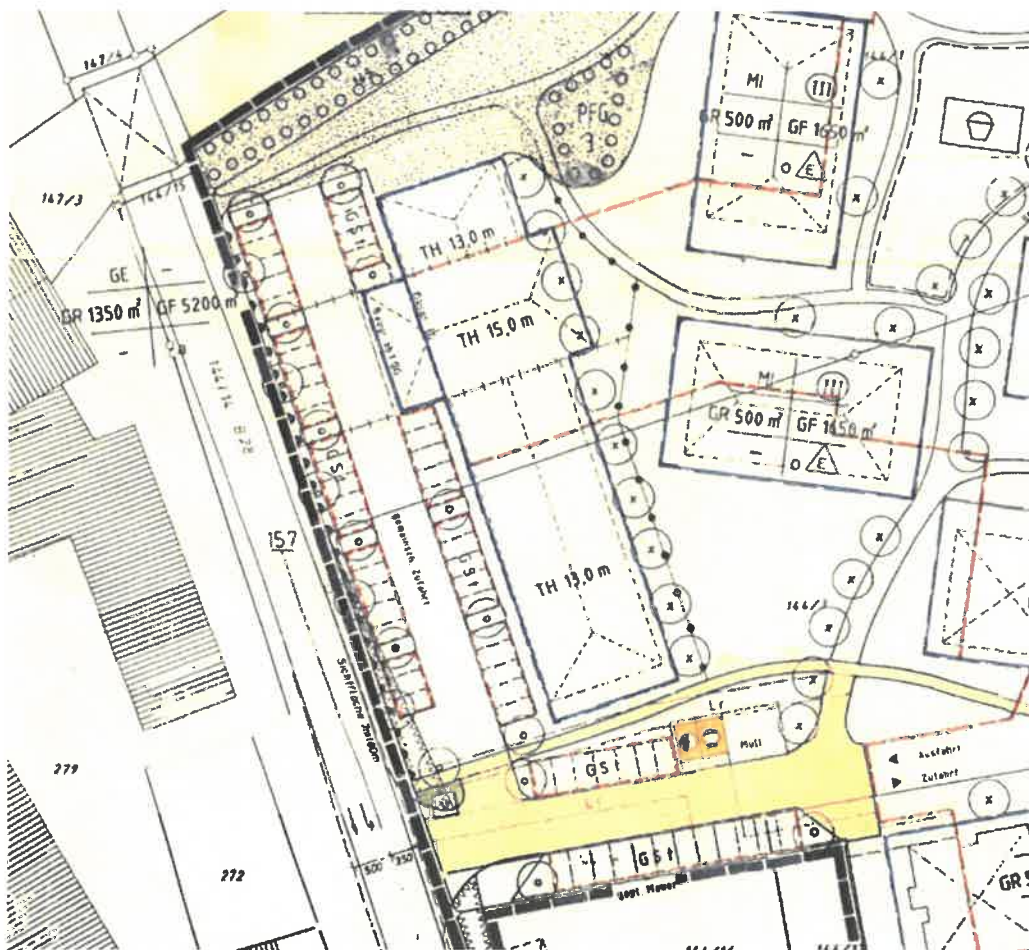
Ausschnitt rechtsgültiger Bebauungsplan „Ohmdwiesen“
